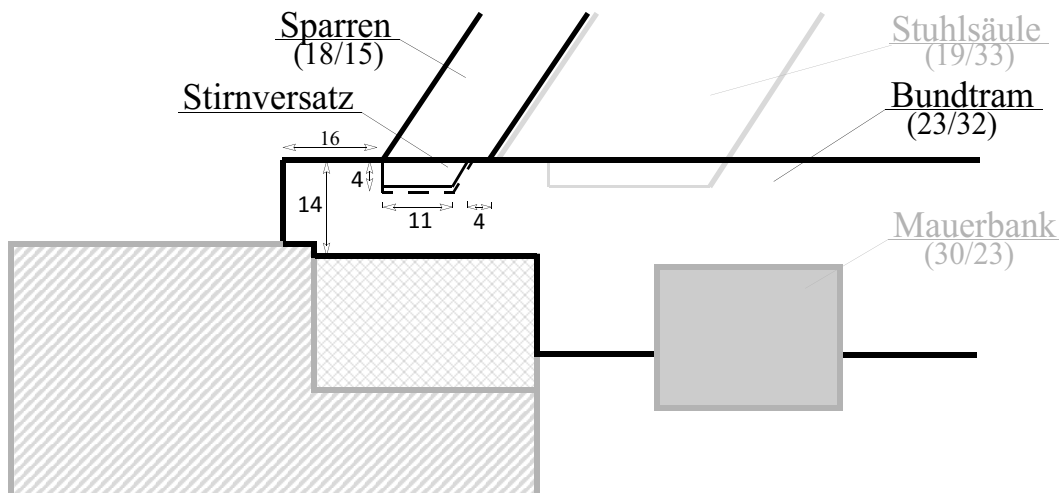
Anschluss: Sparren-Bundtram (Aufriss)
